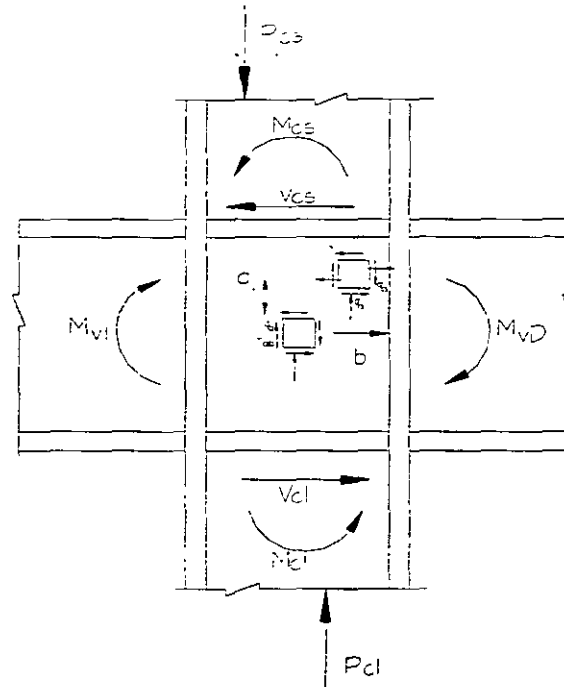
Esfuerzos en el alma de la columna en una junta
